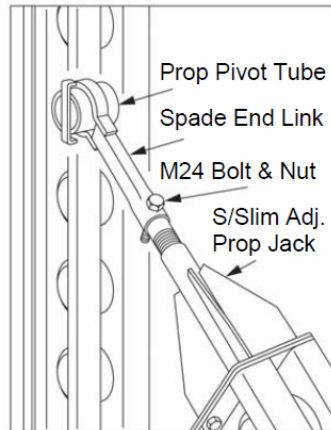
Detalle unión viga Super Slim con espada fijada mediante tubo pivote. Donde Prop Pivot Tube es el tubo pivote, Spade End Link es la espada y Slim Adj Prop Jack es el gato ajustable Slim (RMDKwikform, 2010)
